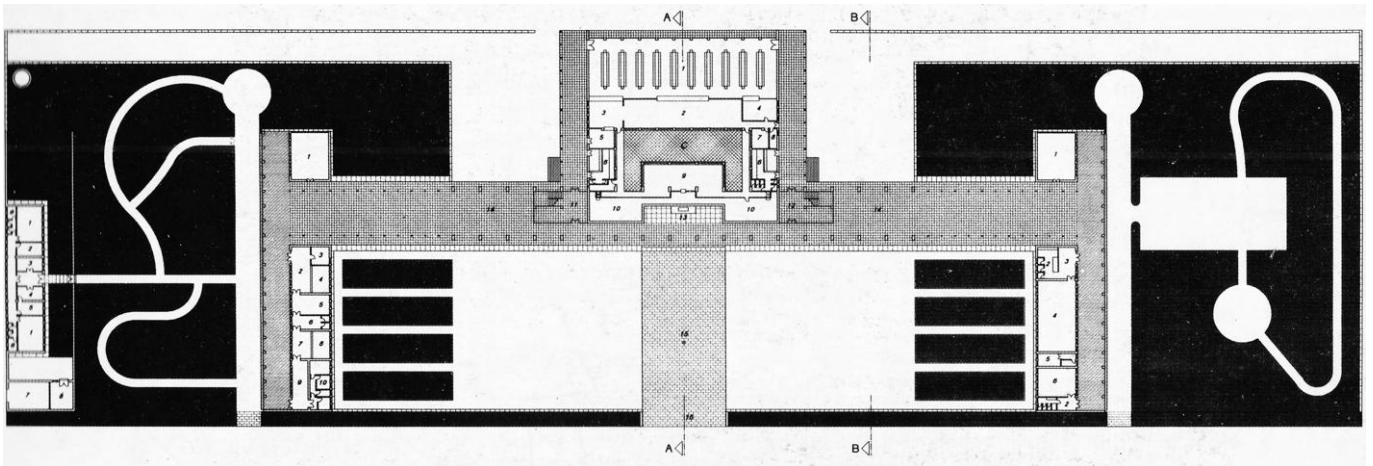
planimetria piano terra, 1938, Archivio Vaccaro
